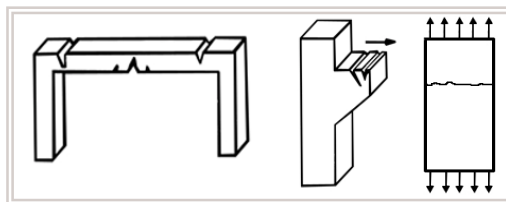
Patologías típicamente observadas en vigas de hormigón armado.
